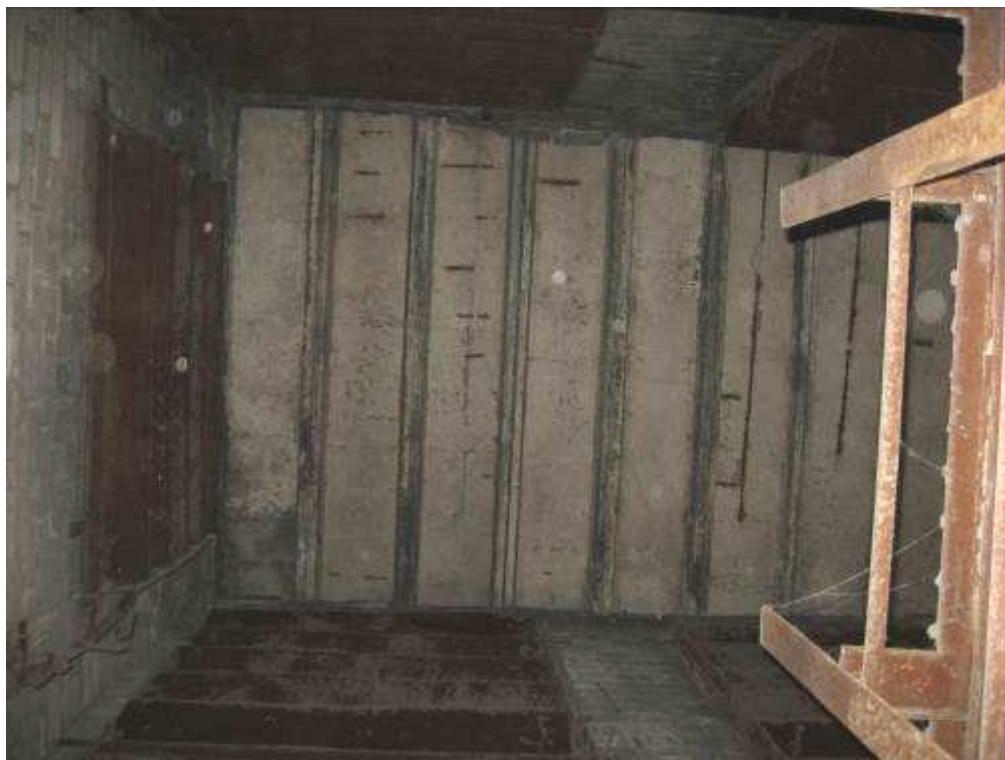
Общий вид сборных железобетонных плит покрытия венткамеры ВК-24
